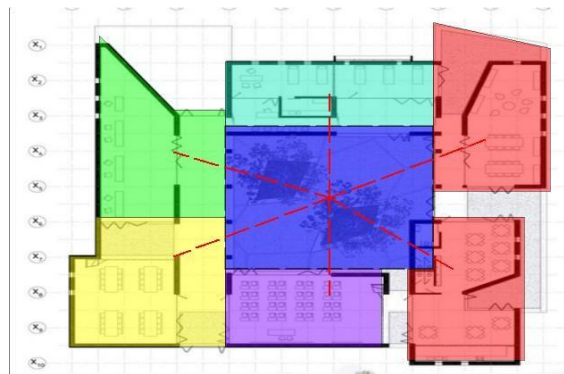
Estructuración del Conjunto, Centro El Alfarcito
